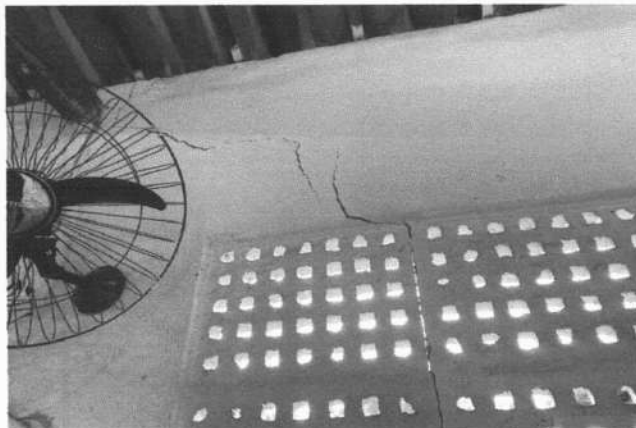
NECESSIDADE DE REFORÇO ESTRUTURAL
